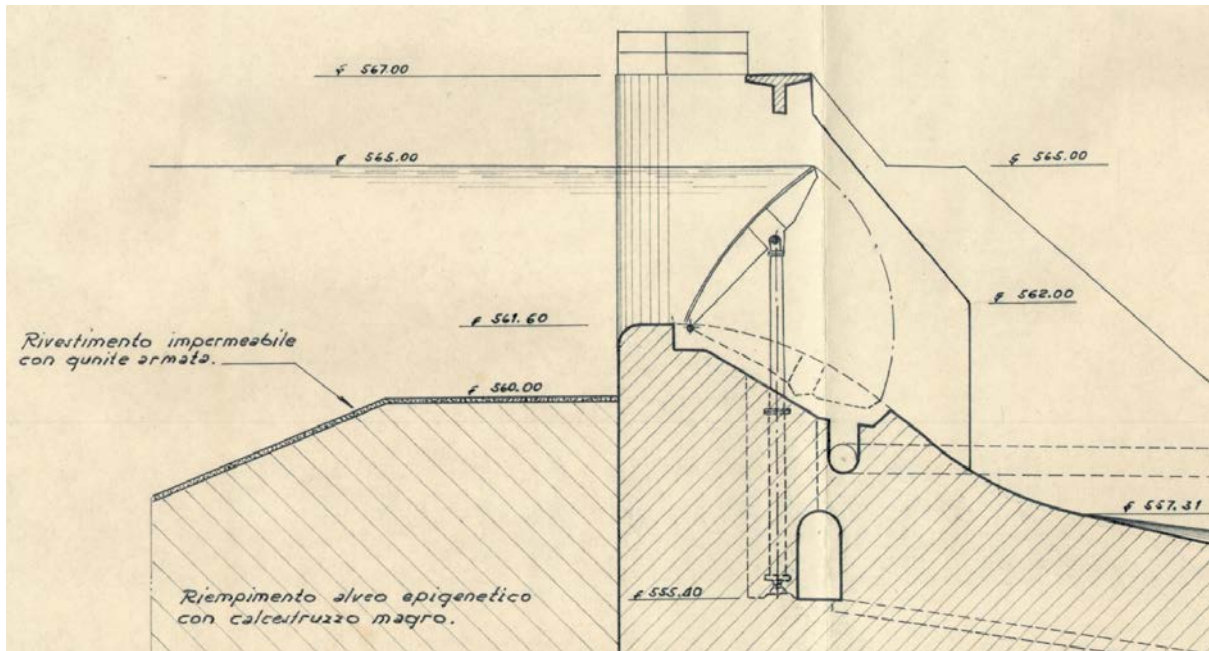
estratto dalla tavola n.28 allegata al collaudo – sezione dello scarico di superficie presidiato da paratoie.
